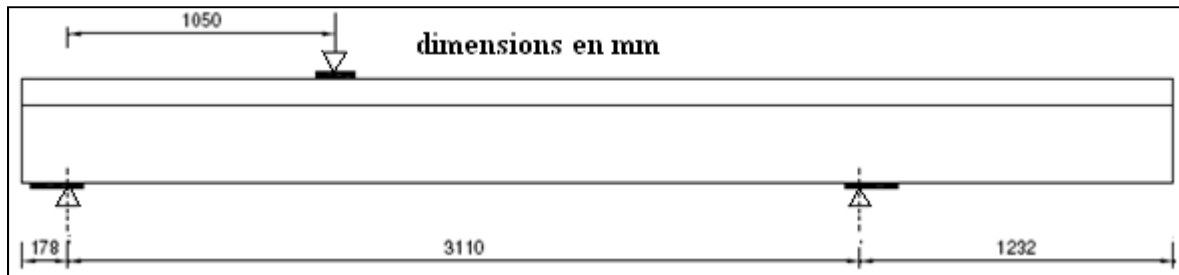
Positionnement d'un spécimen sur le banc d'essais.
